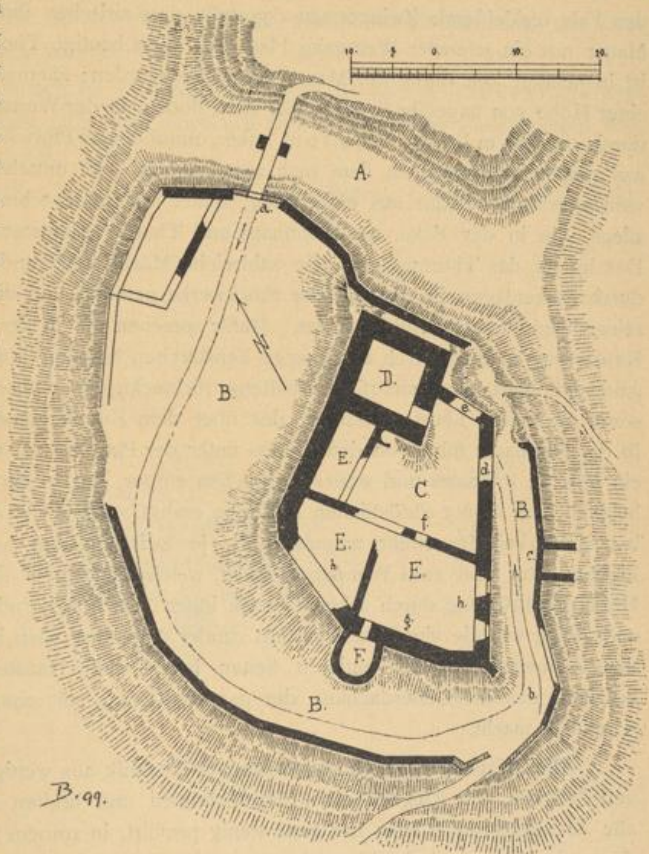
Waldkirch. Ruine Kastelberg, Plan.
